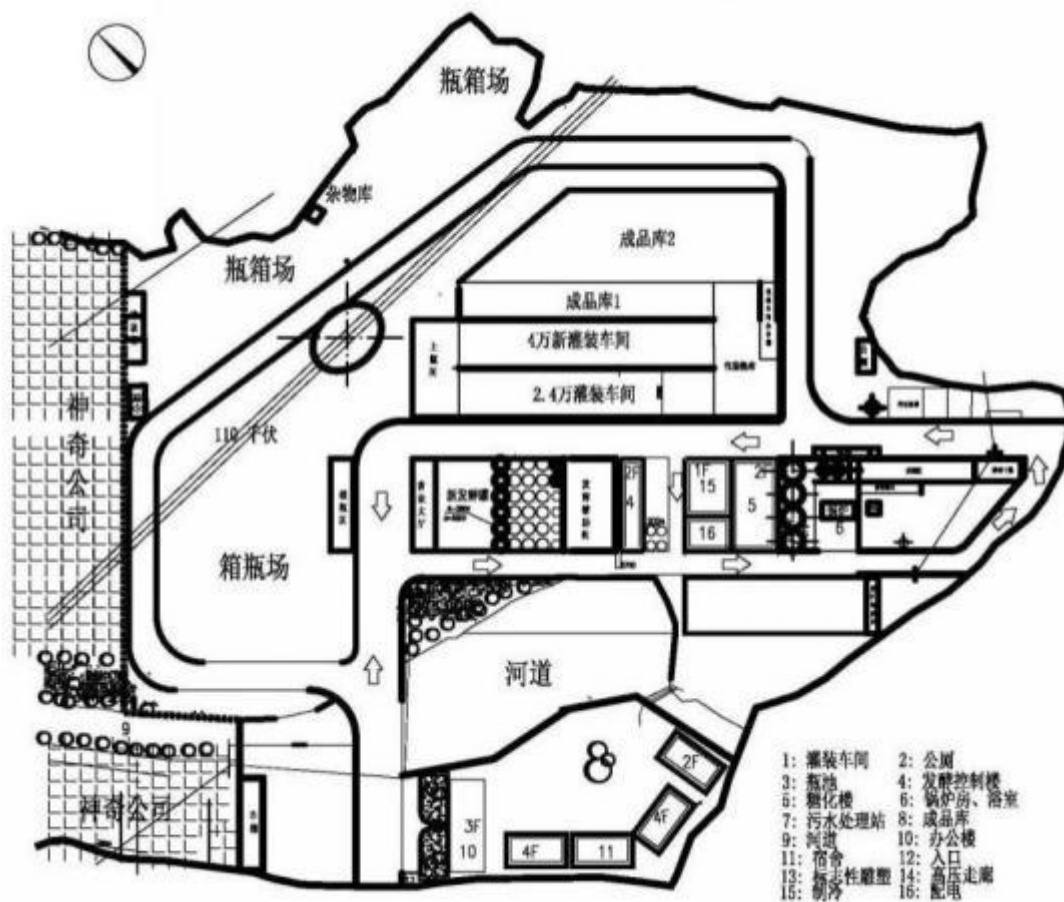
华润雪花啤酒(黔南)有限公司原厂平面布置图
